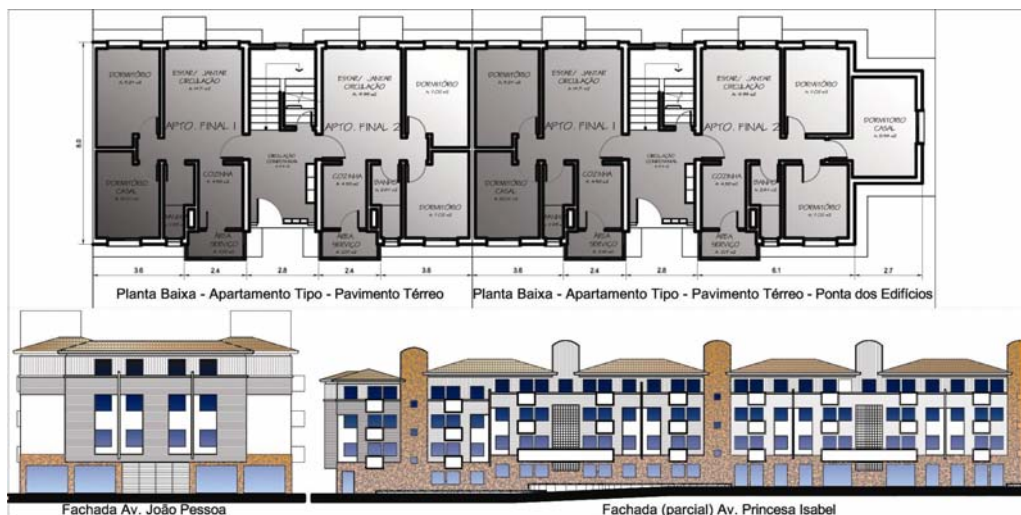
Planta baixa e Fachada do bloco tipo do Condomínio Princesa Isabel
